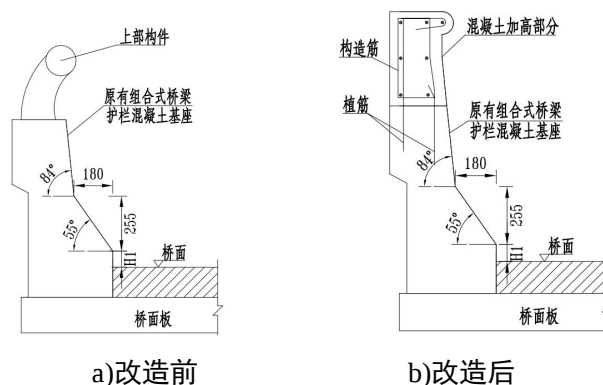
加高混凝土桥梁护栏改造方案 (mm)
